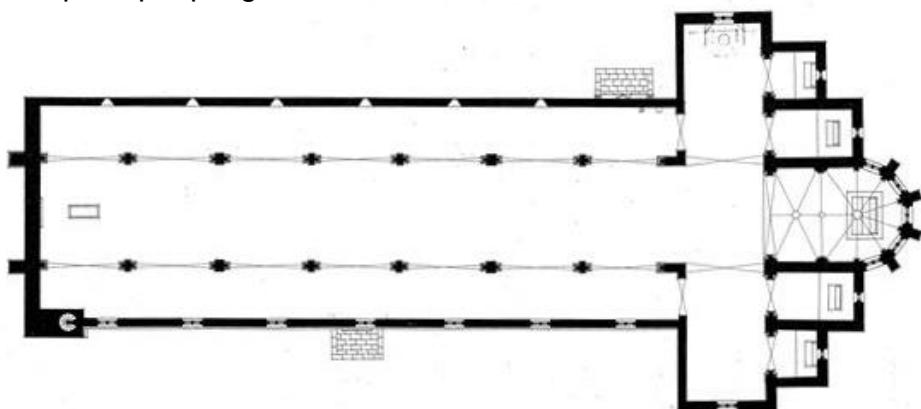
Planta do Convento de Santa Clara. Fonte DGEMN.
